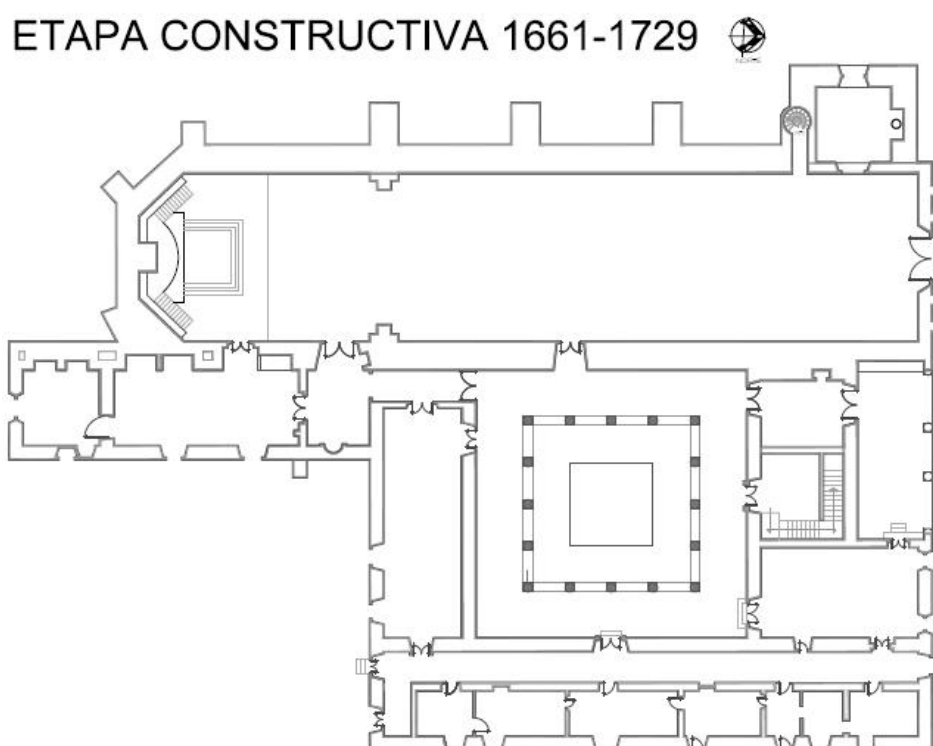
Planta arquitectónica, etapa constructiva 1661-1729⁵⁸
